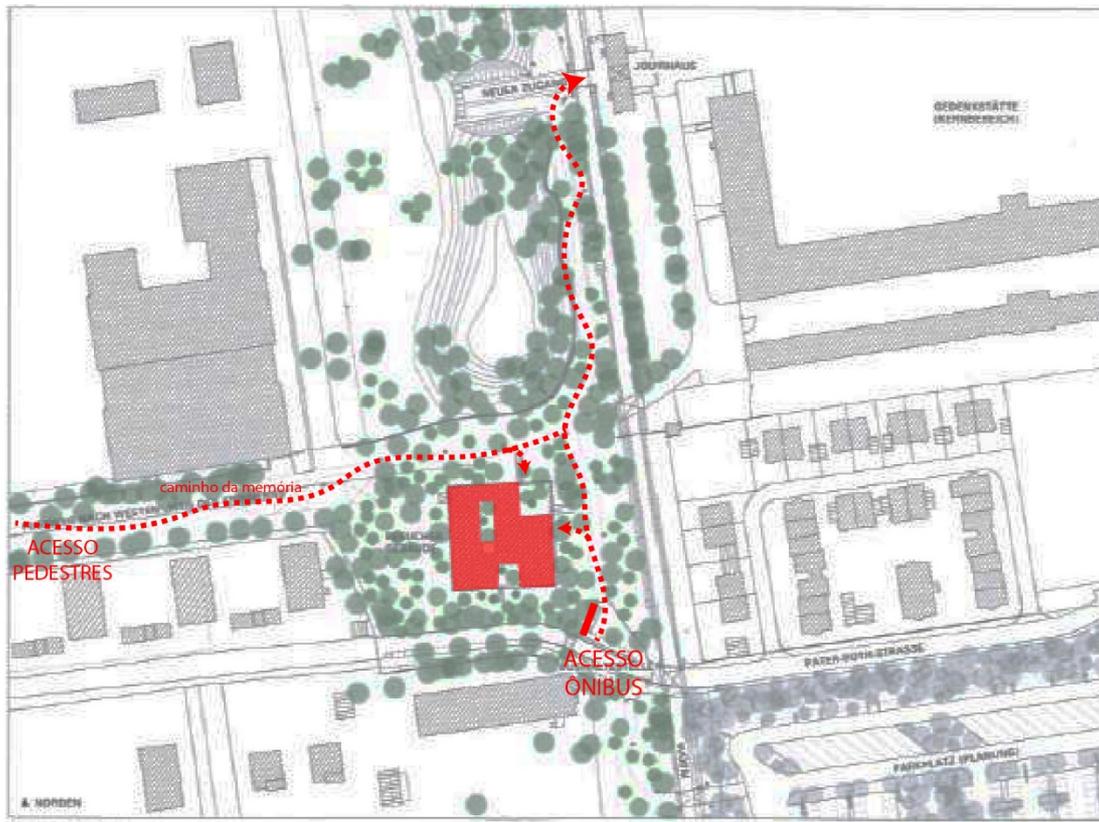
CV DACHAU - LOCALIZAÇÃO
